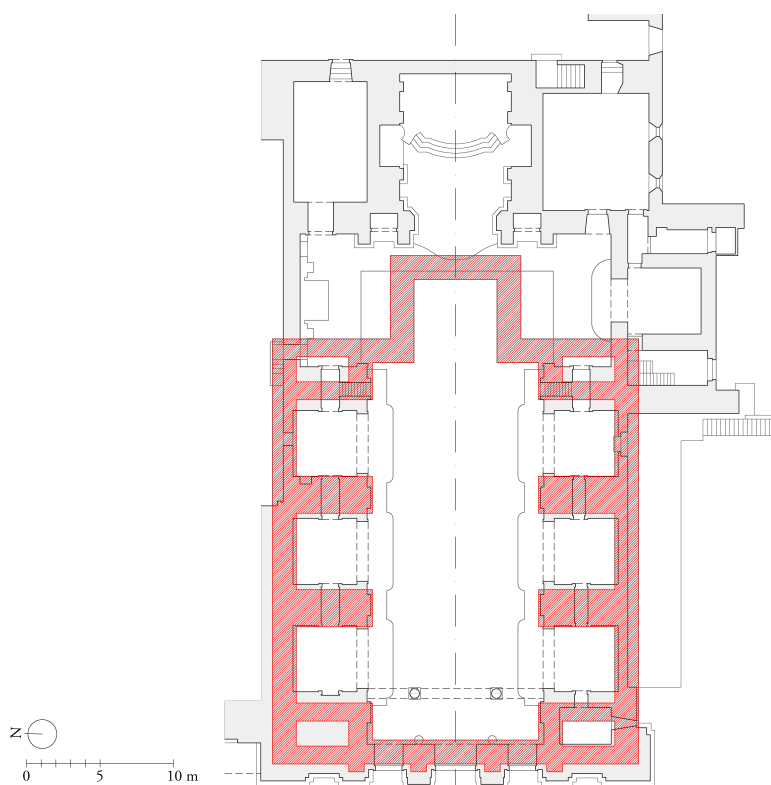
, Sobreposição da planta da igreja de São Lourenço, Porto, com planta gerada pela GF<sub>AE</sub> (a vermelho).
